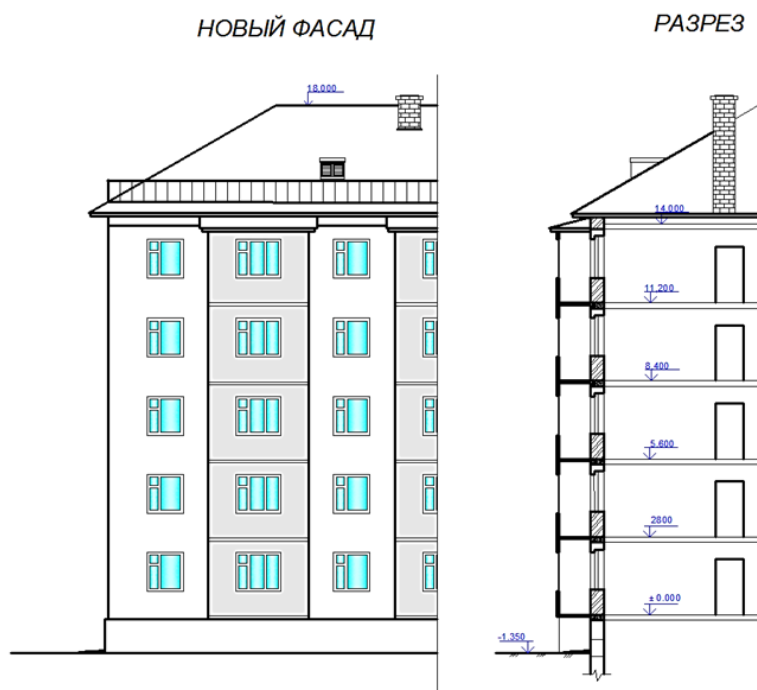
Фрагменты фасада и поперечного сечения типового жилого дома после реконструкции.
